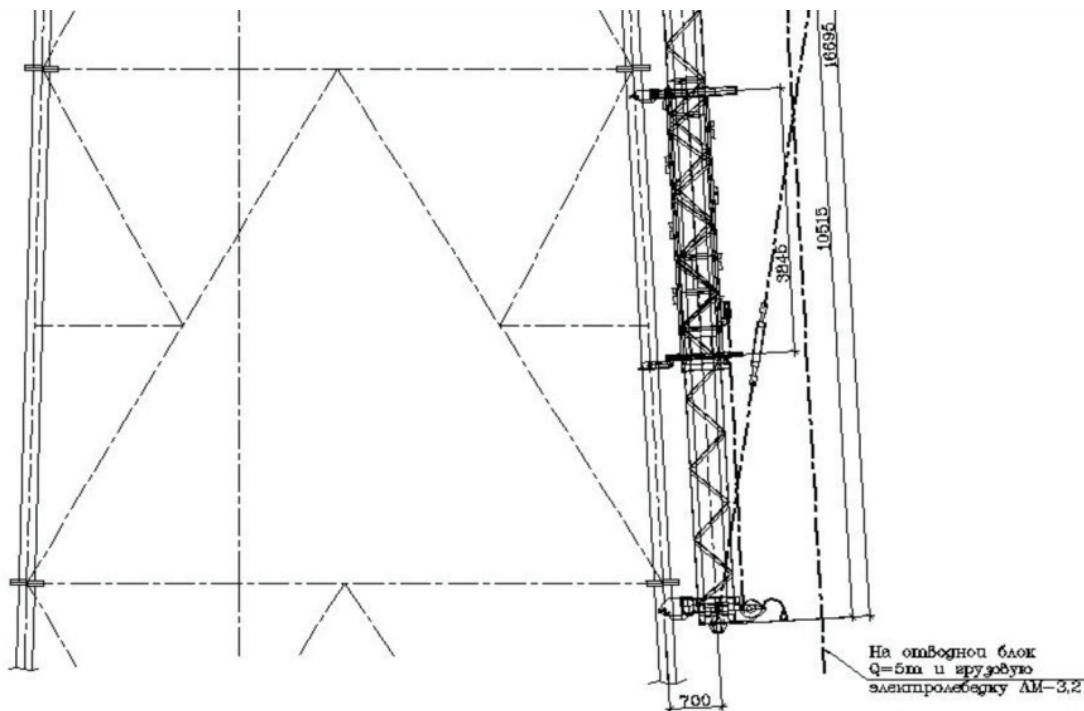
Схема опирания крана УПК-4 на опорную балку
